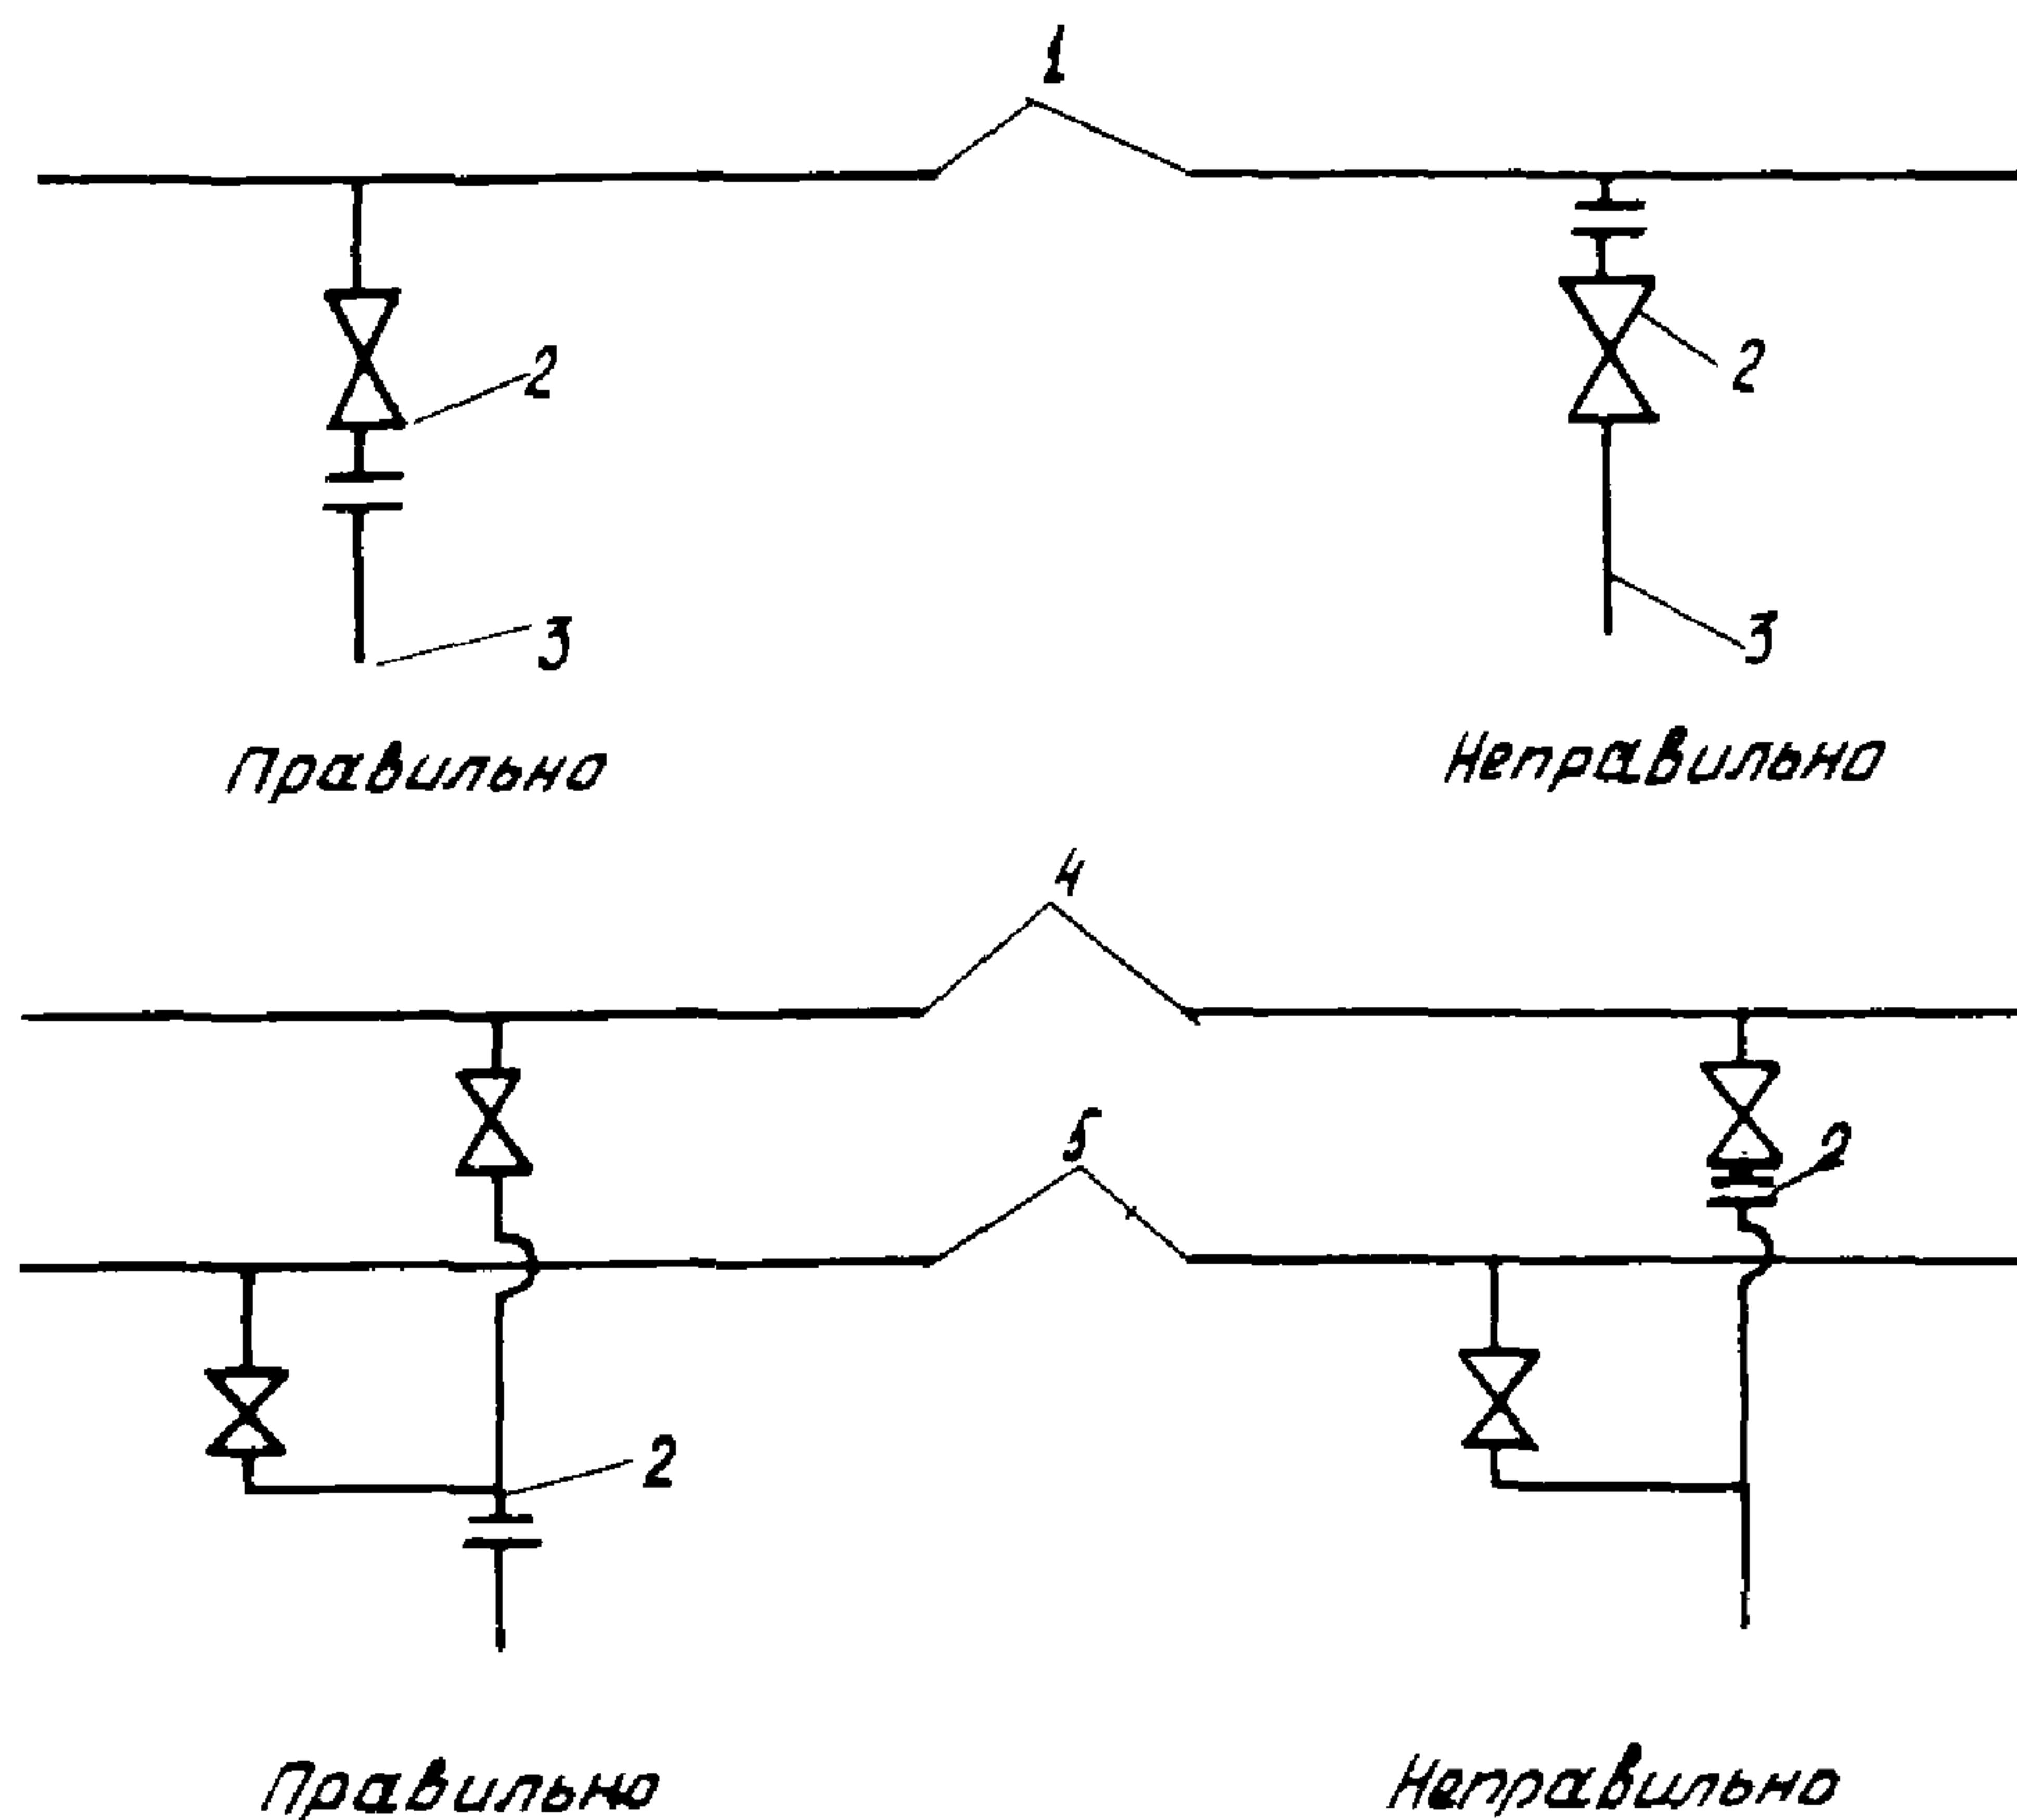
Установка изолирующего фланца на отводах от магистральных трубопроводов:
